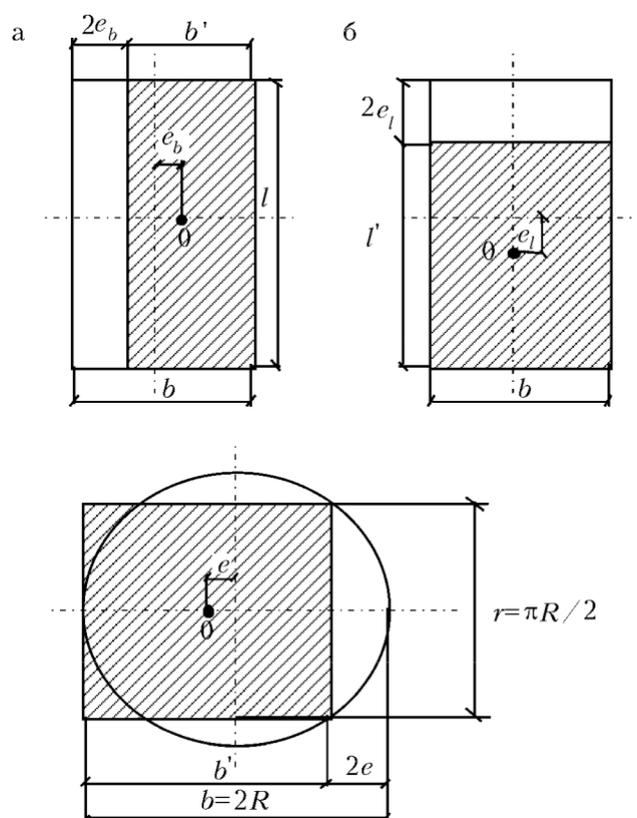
Схемы для определения приведенных размеров подошвы фундамента:
